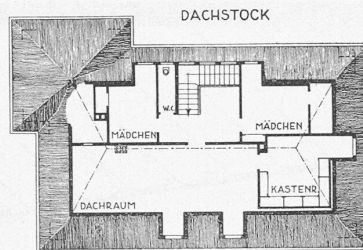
bis 9. Grundriss 1 : 400 zum
